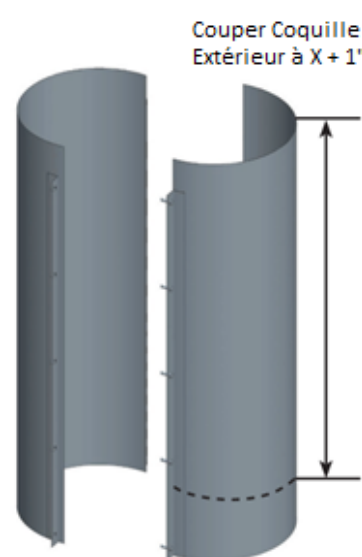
Étape 3 - Coupe du boîtier extérieur
